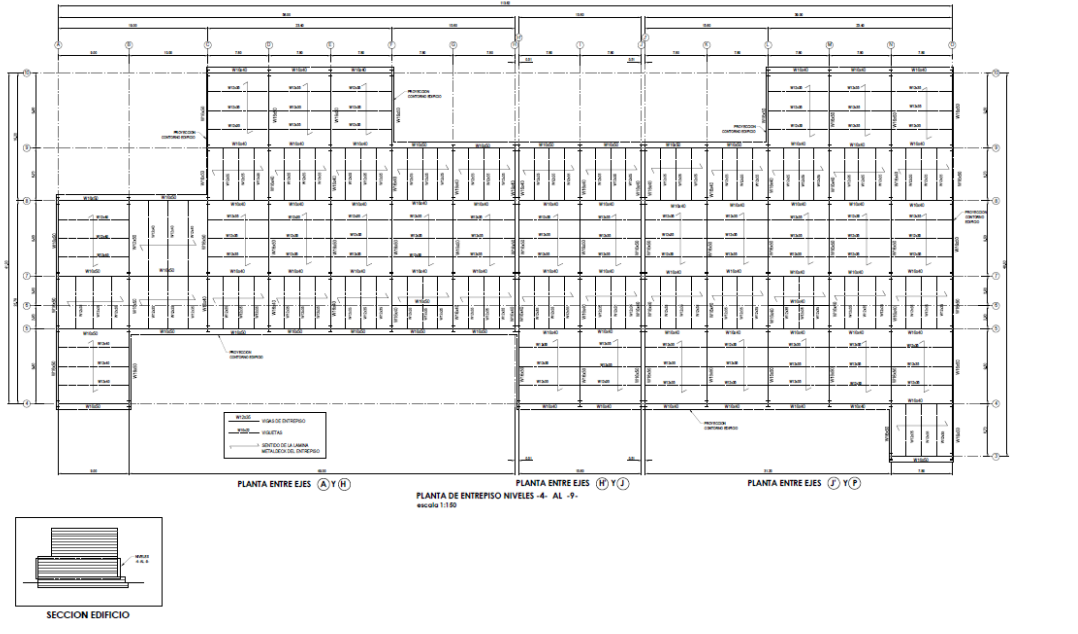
Planta Estructural Entrepiso Nivel 4-9
